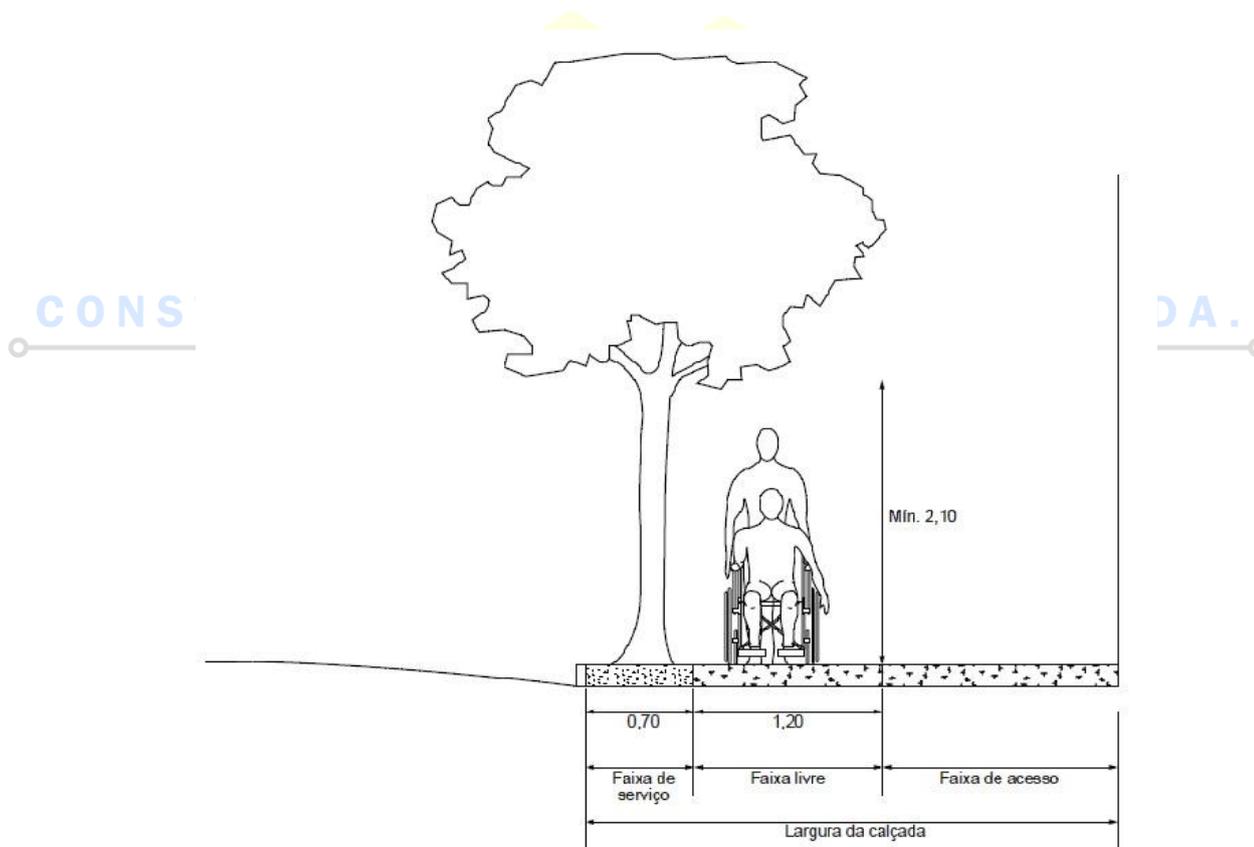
Faixas de uso da calçada, em corte (Fonte NBR 9050)
